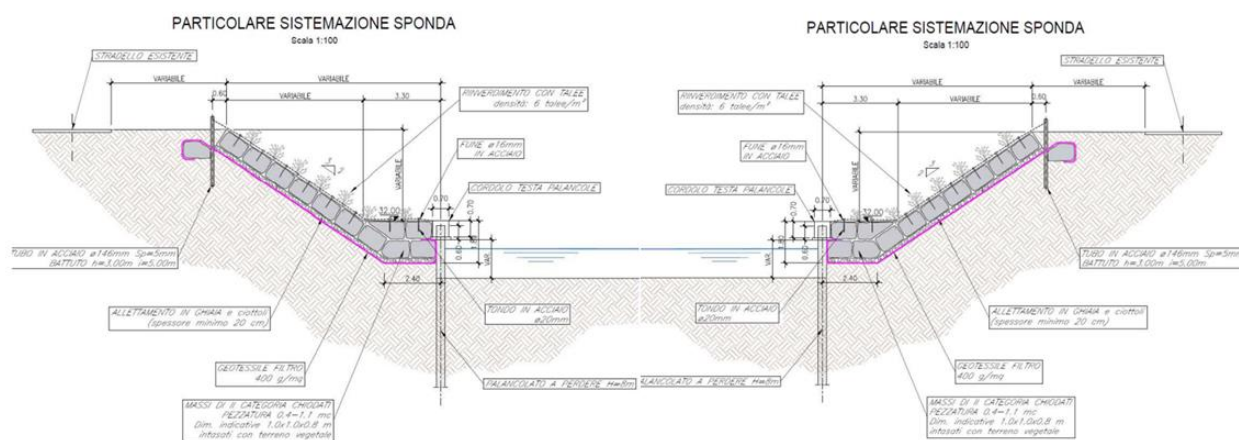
Sezione della sistemazione di progetto sulla sponda destra e sinistra
